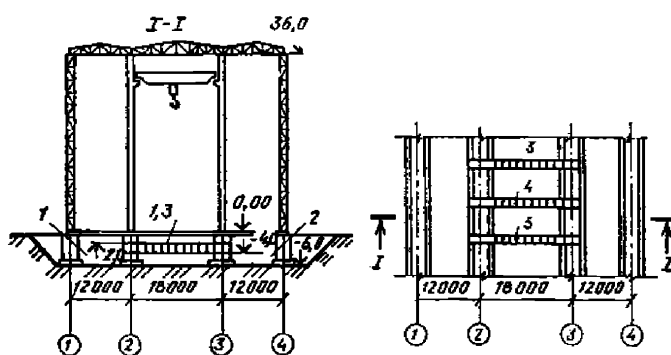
Строительство тоннелей внутри здания, совмещенное с укладкой фундаментов:
